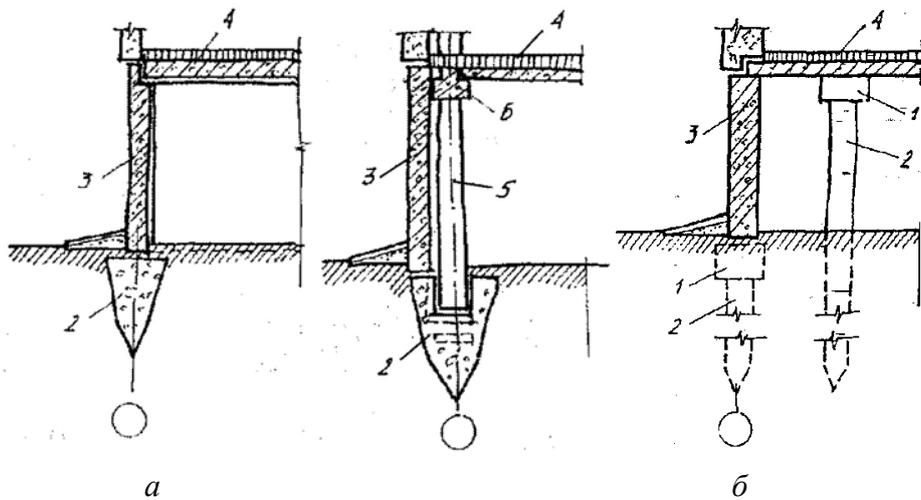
Типы свайных фундаментов: а — свайный безростверковый фундамент; б — свайные фундаменты без ростверков и оголовков: 1 — свая; 2 — оголовок; 3 — цокольная панель; 4 — перекрытия; 5 — колонна; 6 — ригель
